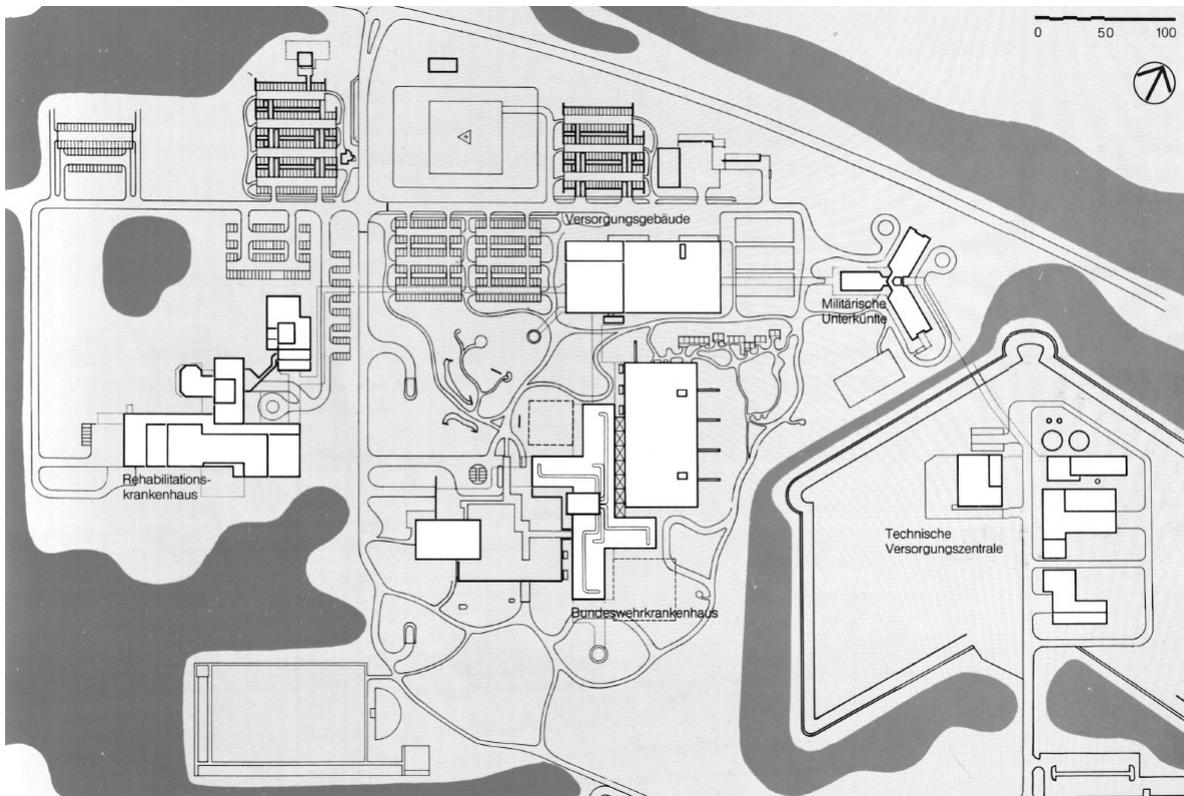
BwKrhS Ulm und Nachbargebäude, Lageplan
